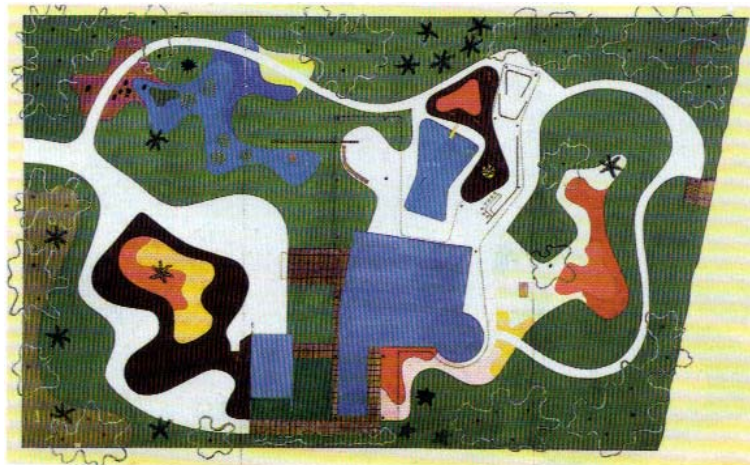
Casa Burton Tremaine - planta do jardim - 1948
